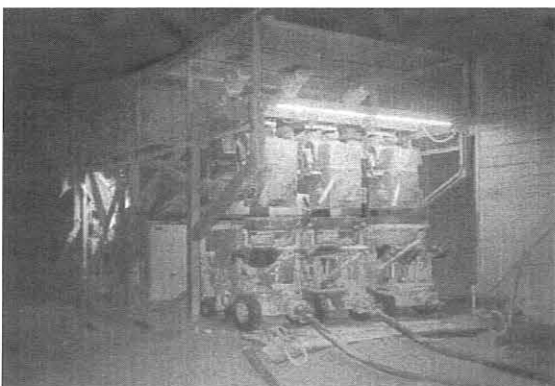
3-bahnige Spritzanlage im Tunnel Umfahrung Landeck Nord
